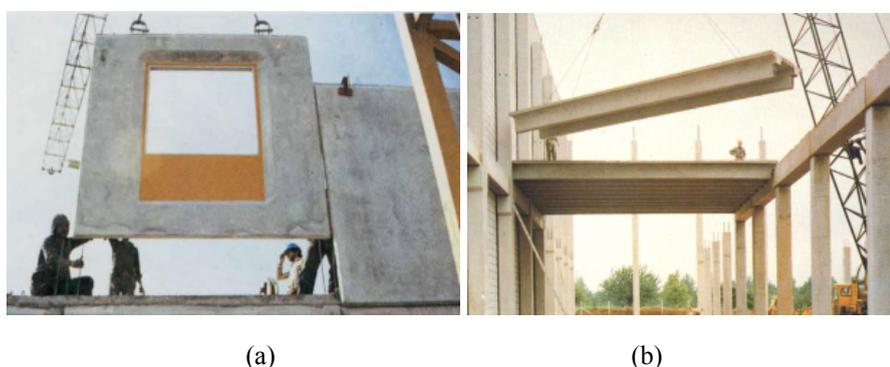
(a) montagem de painéis; (b)montagem das lajes pré-fabricadas
